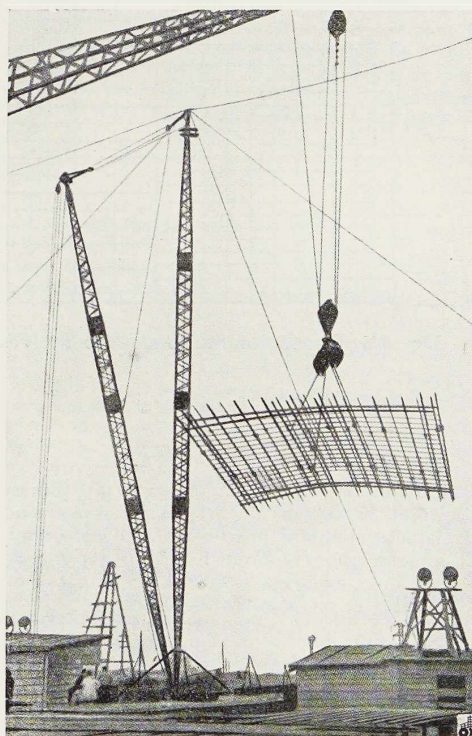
Mise en place des panneaux d'armature des dalles en béton au moyen d'un derrick.
